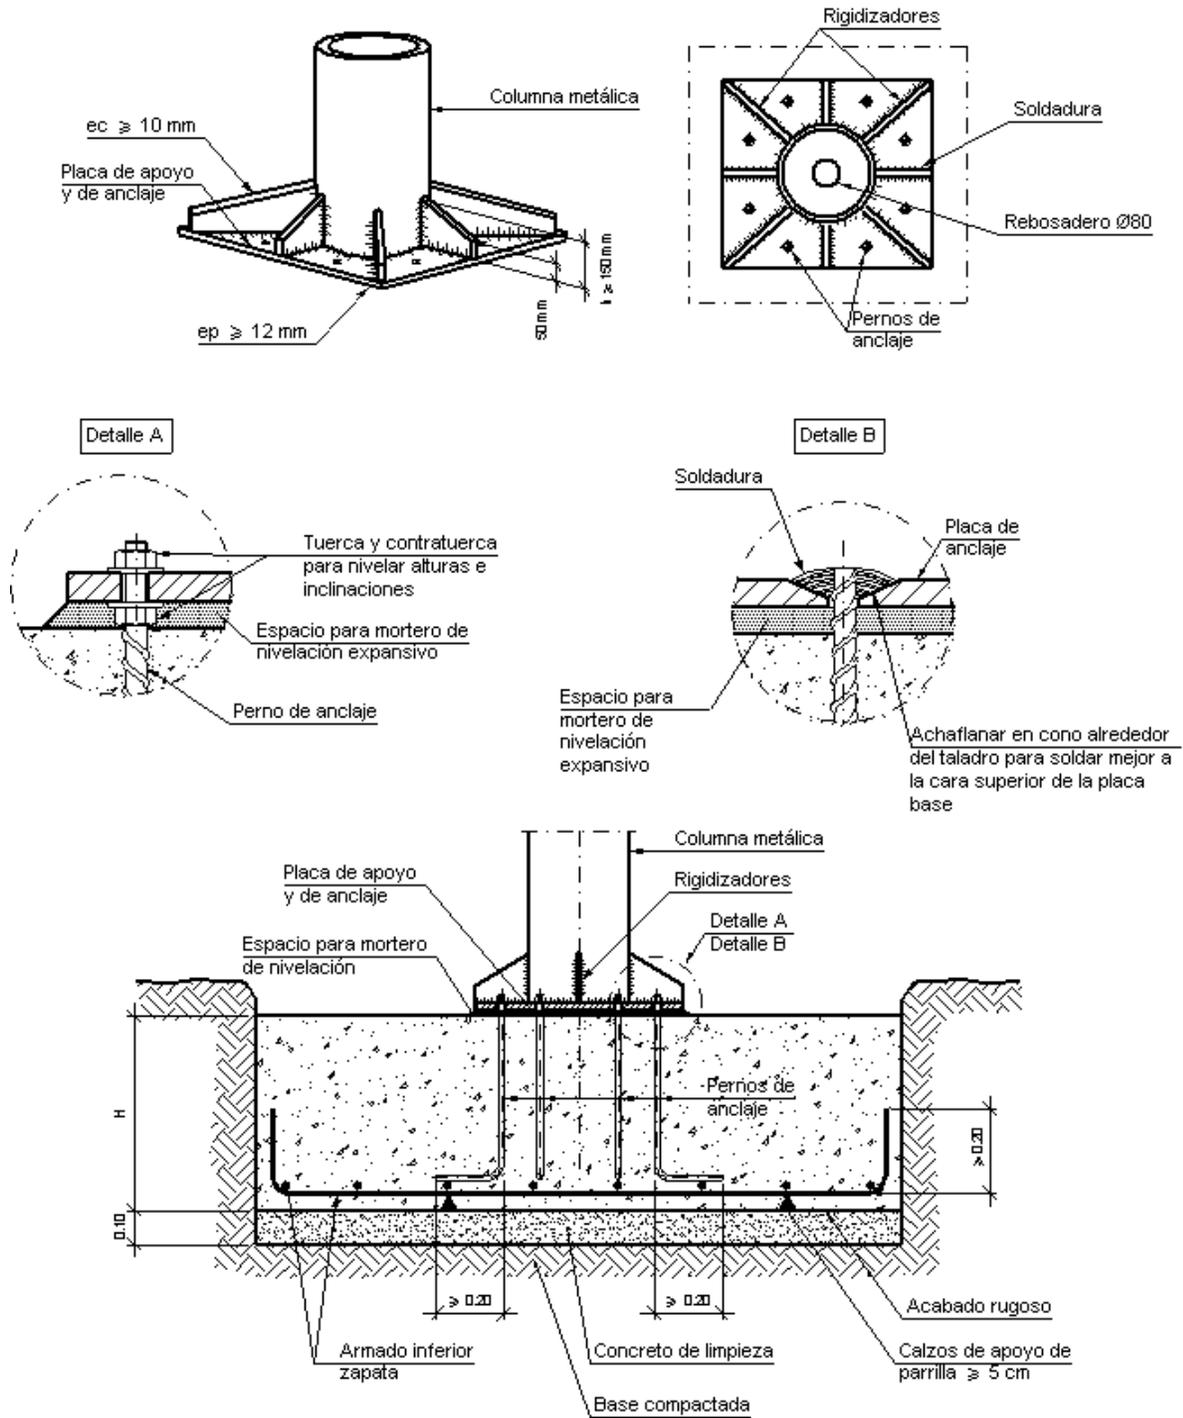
Ejempló de Zapatas aisladas (Apuntes personales de la materia de Estructuras de Acero)
